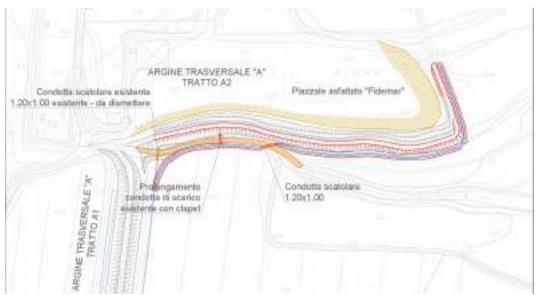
planimetria degli interventi previsti lungo il tratto A2 dell'argine trasversale A
